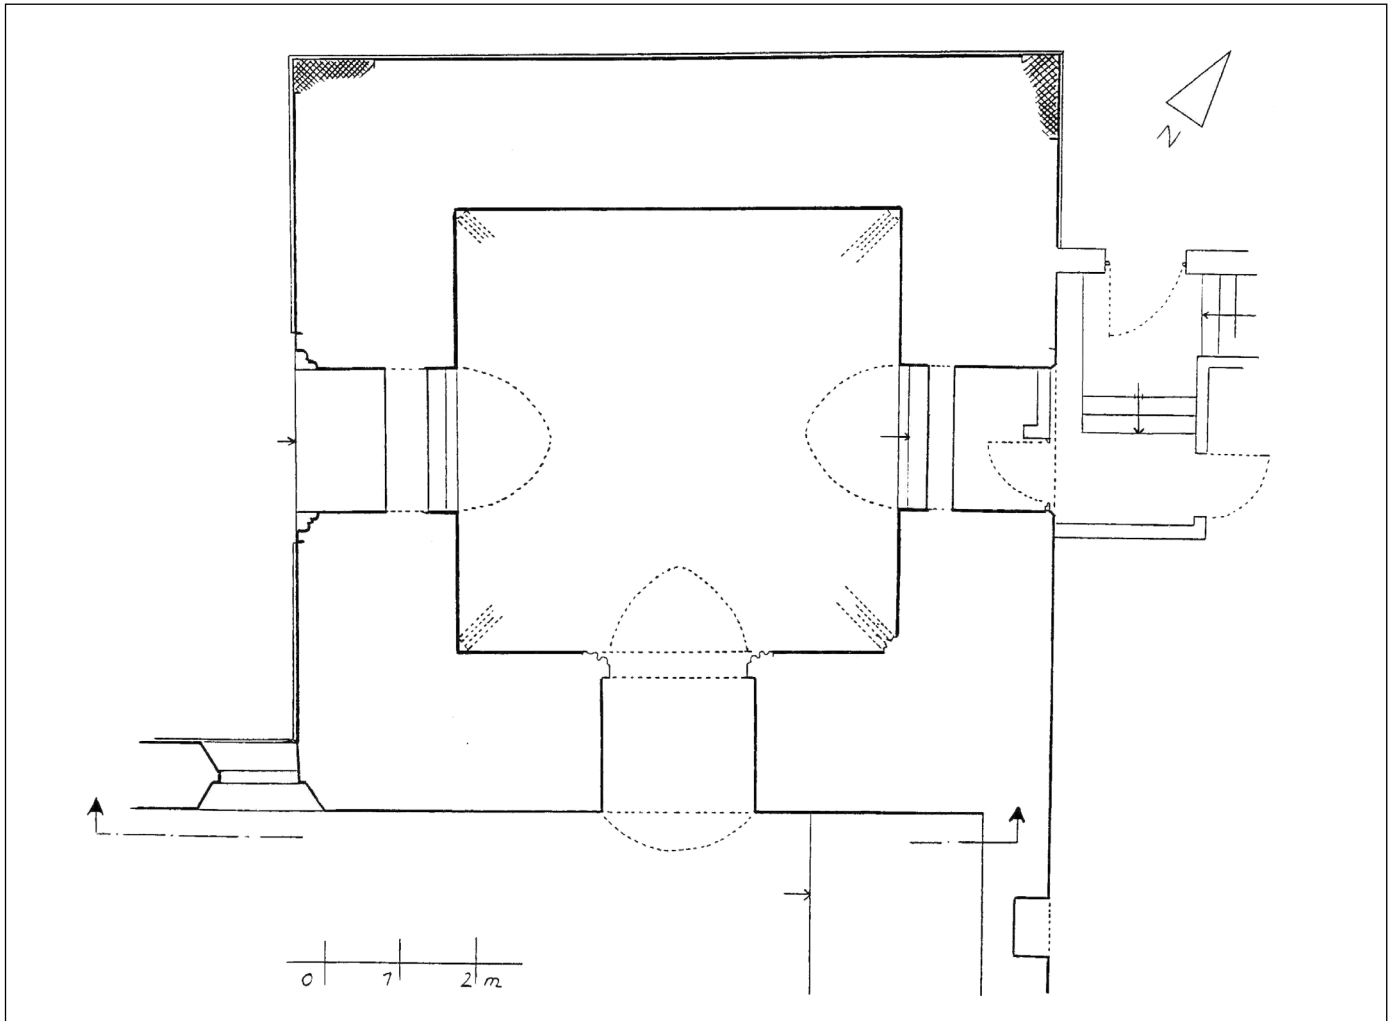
Kirchstraße 17, Kirchturm St. Martin, Grundriss Erdgeschoss.
